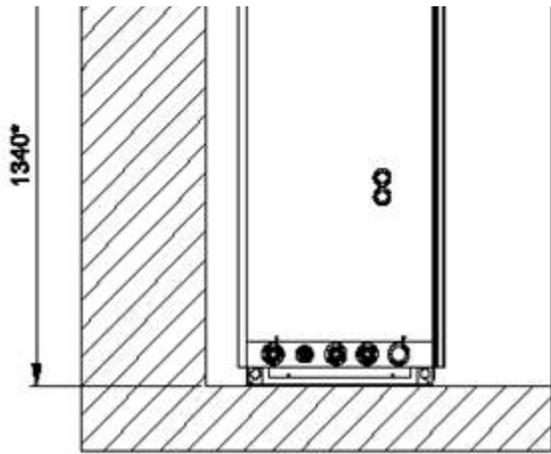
Vista laterale - LIK 8TES (installazione ad angolo)
